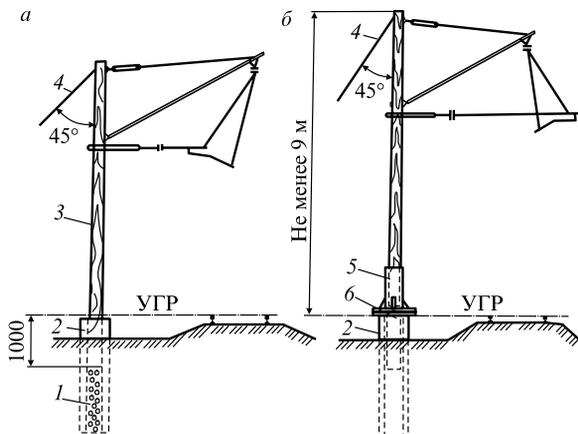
Схемы установки деревянных опор в сруб железобетонной опоры непосредственно (а) и с помощью стаканного фундамента (б): 1 — засыпной грунт; 2 — сруб железобетонной опоры; 3 — деревянная опора; 4 — оттяжка; 5 — основание опоры; 6 — закладной фундамент
